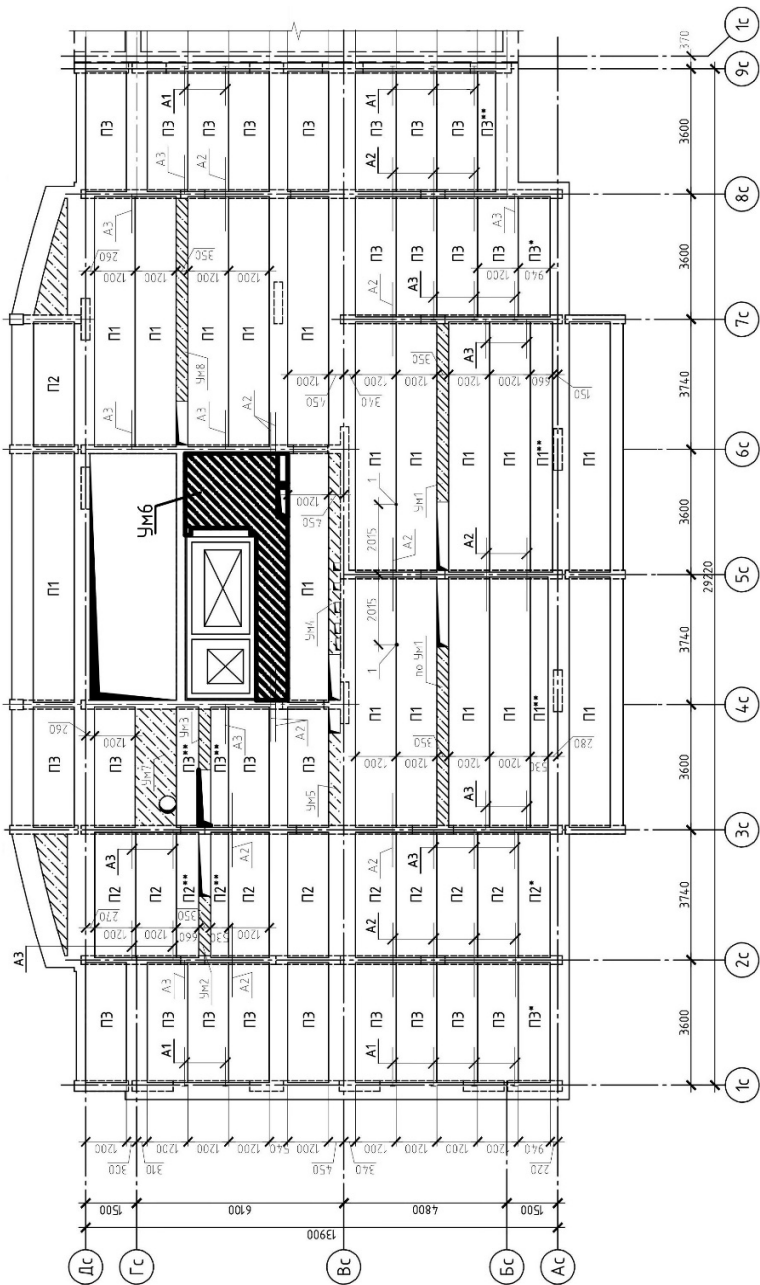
Монолитный участок и расположение его на общем плане конструкции междуэтажного перекрытия здания (Умб)
